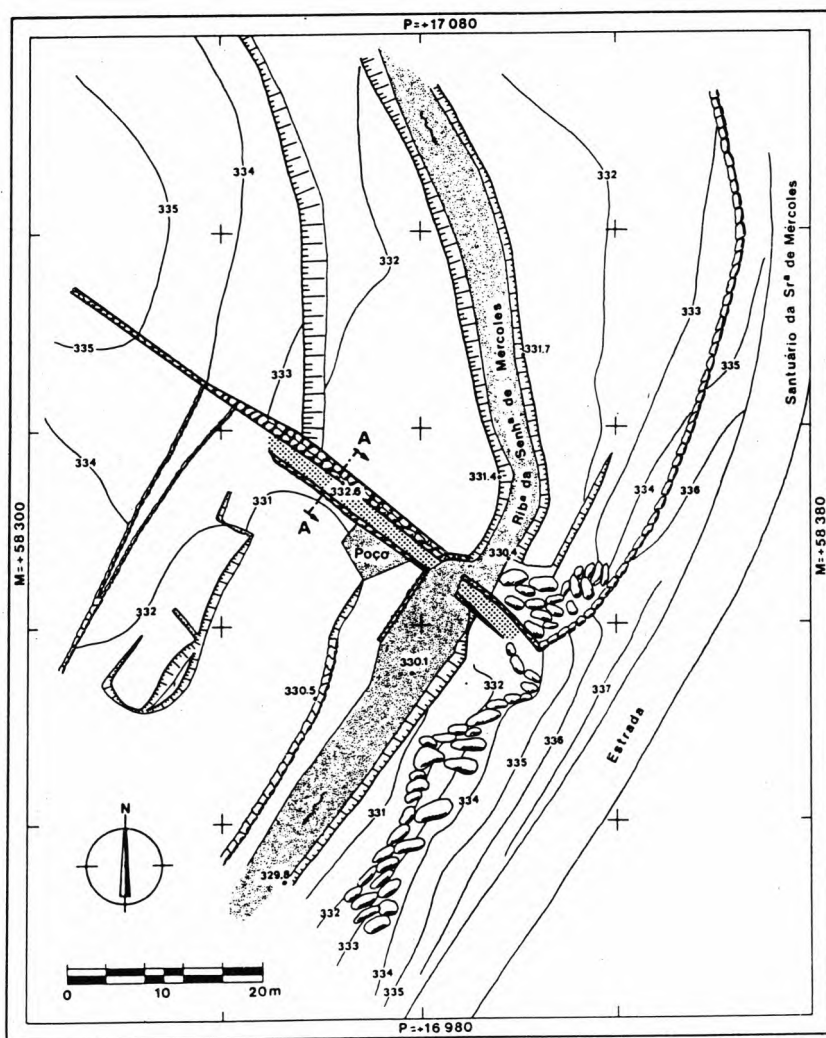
Barragem da de Nossa Senhora de Mércoles(Castelo Branco). Planta da barragem
